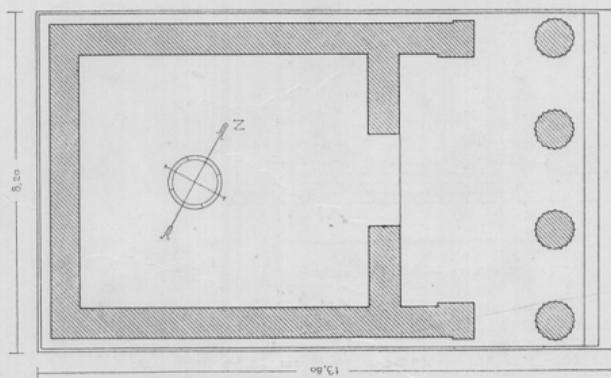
Posizione delle murature di elevato rispetto alle fondazioni.
